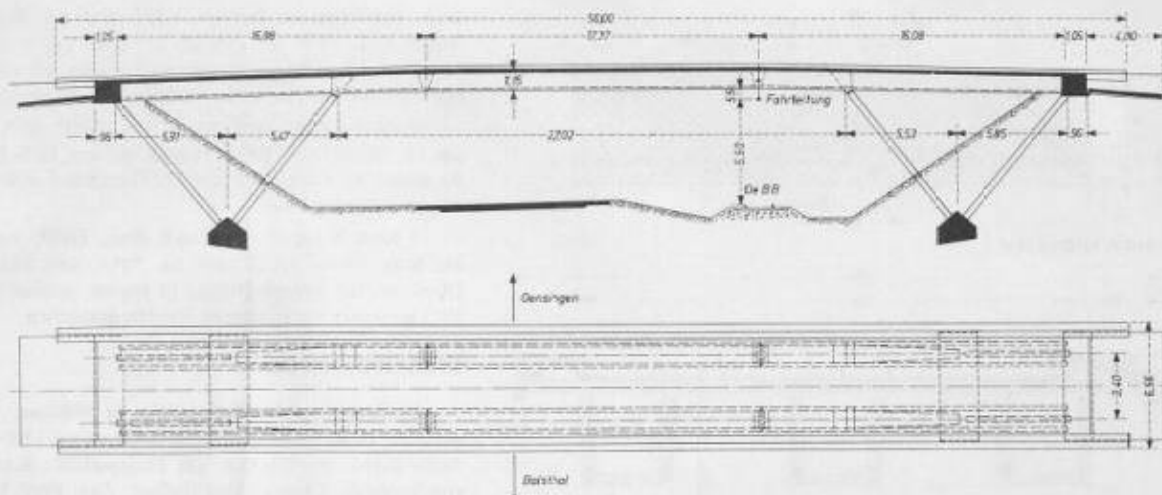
Ueberführung Oensingen. Längsschnitt und Grundriss 1:400
